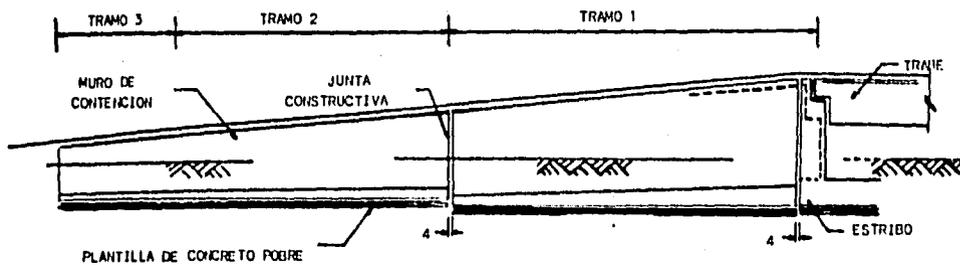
ELEVACIÓN DE RAMPA DE ACCESO
